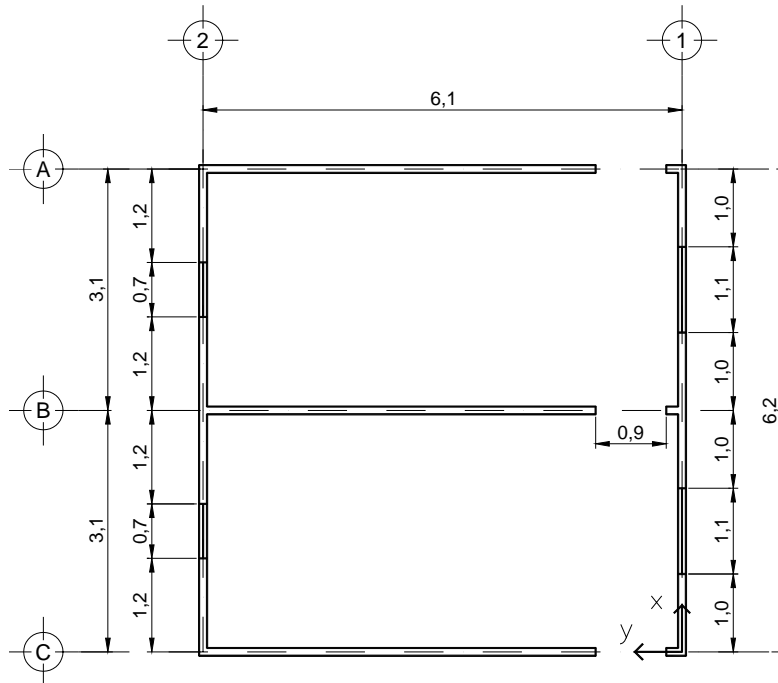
Planta de muros viviendas Tipo 2 (acotaciones en m)
